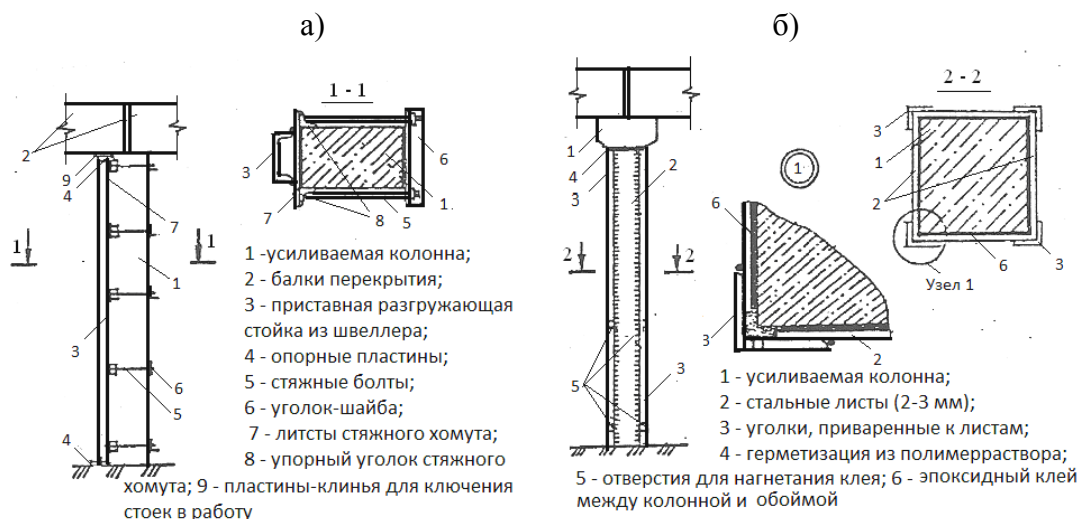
Усиление железобетонных колонн установкой приставных разгружающих стоек (а) и устройством стальной облоймы (б)
